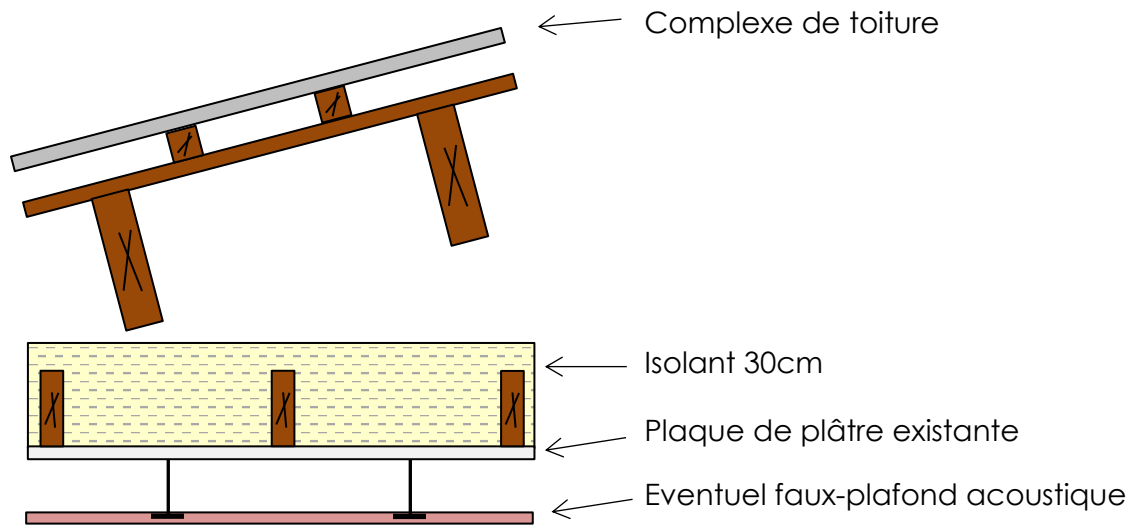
Schéma de principe en coupe – Complexe de toiture sur combles techniques
